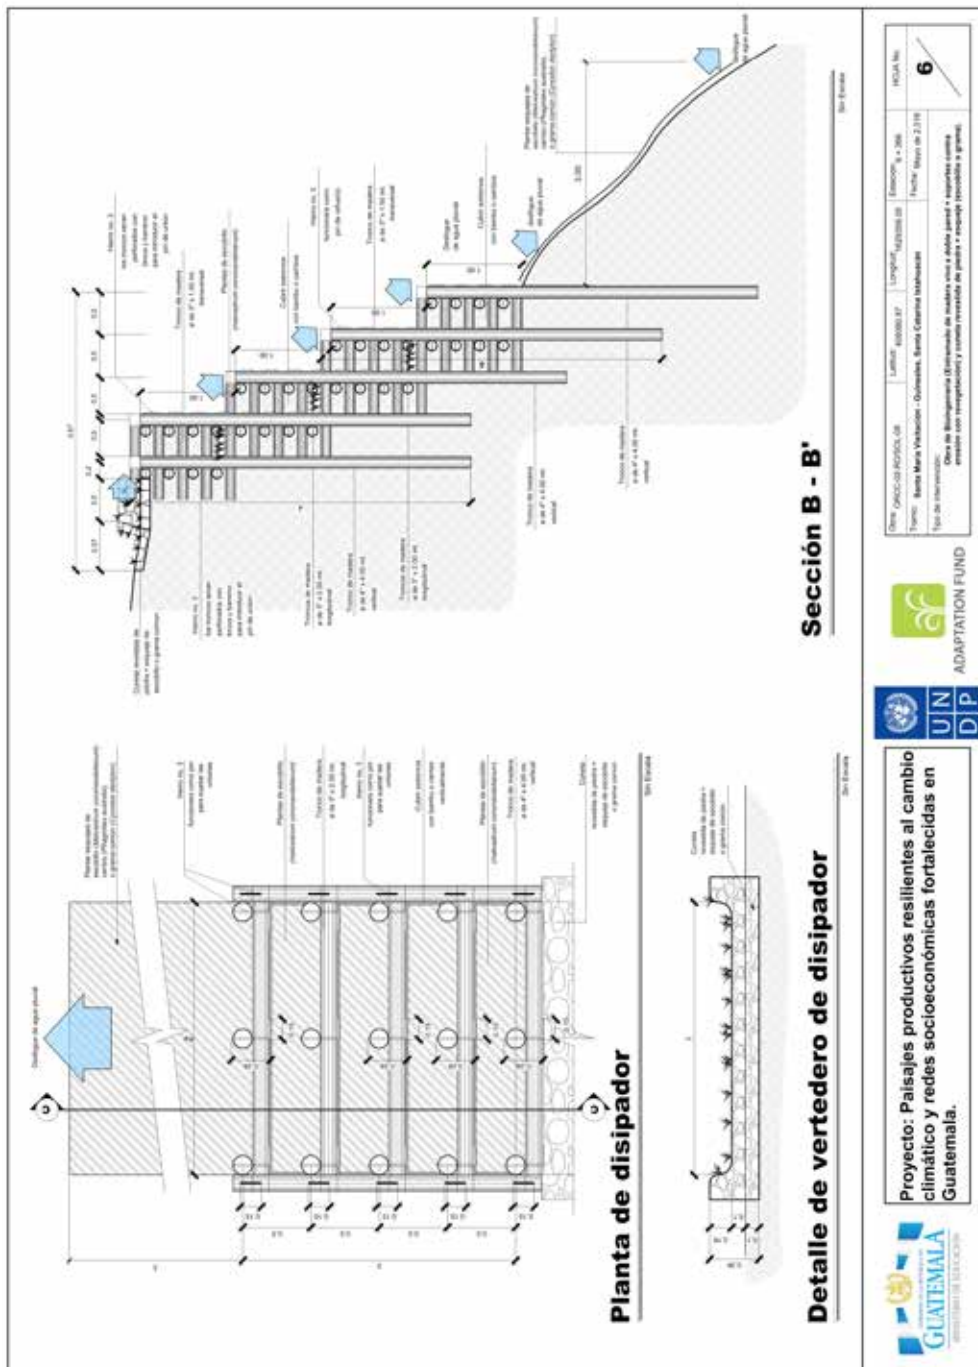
A. DETALLE DISIPADOR. SECCIÓN B-B'. Planificación Obra ORCC-02/RD-SOL-08. Tramo: (Santa María Visitación-Guineales, Sta. Catarina Ixtahuacán)
